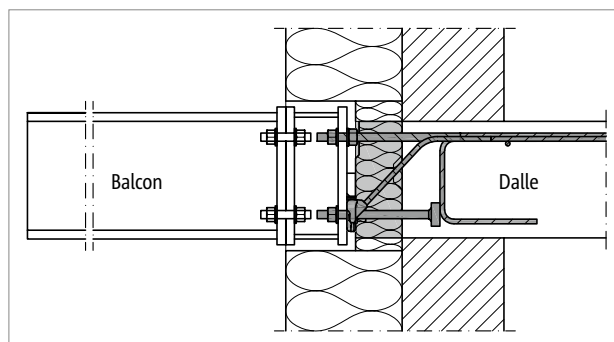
Schöck Isokorb® T type SK : raccordement de la poutre en acier à un adaptateur permettant de compenser l'épaisseur de l'isolation thermique extérieure
